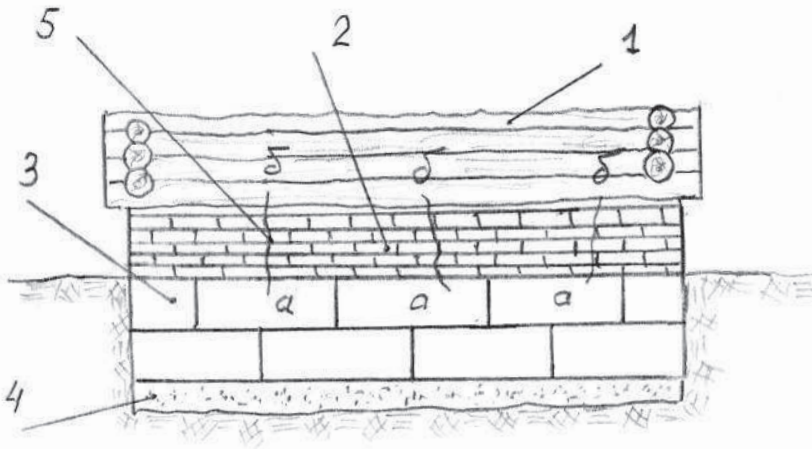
Разрушение цоколя блочного фундамента: 1 — сруб; 2 — кирпичный цоколь; 3 — фундаментные блоки; 4 — песчаная засыпка; 5 — трещины
